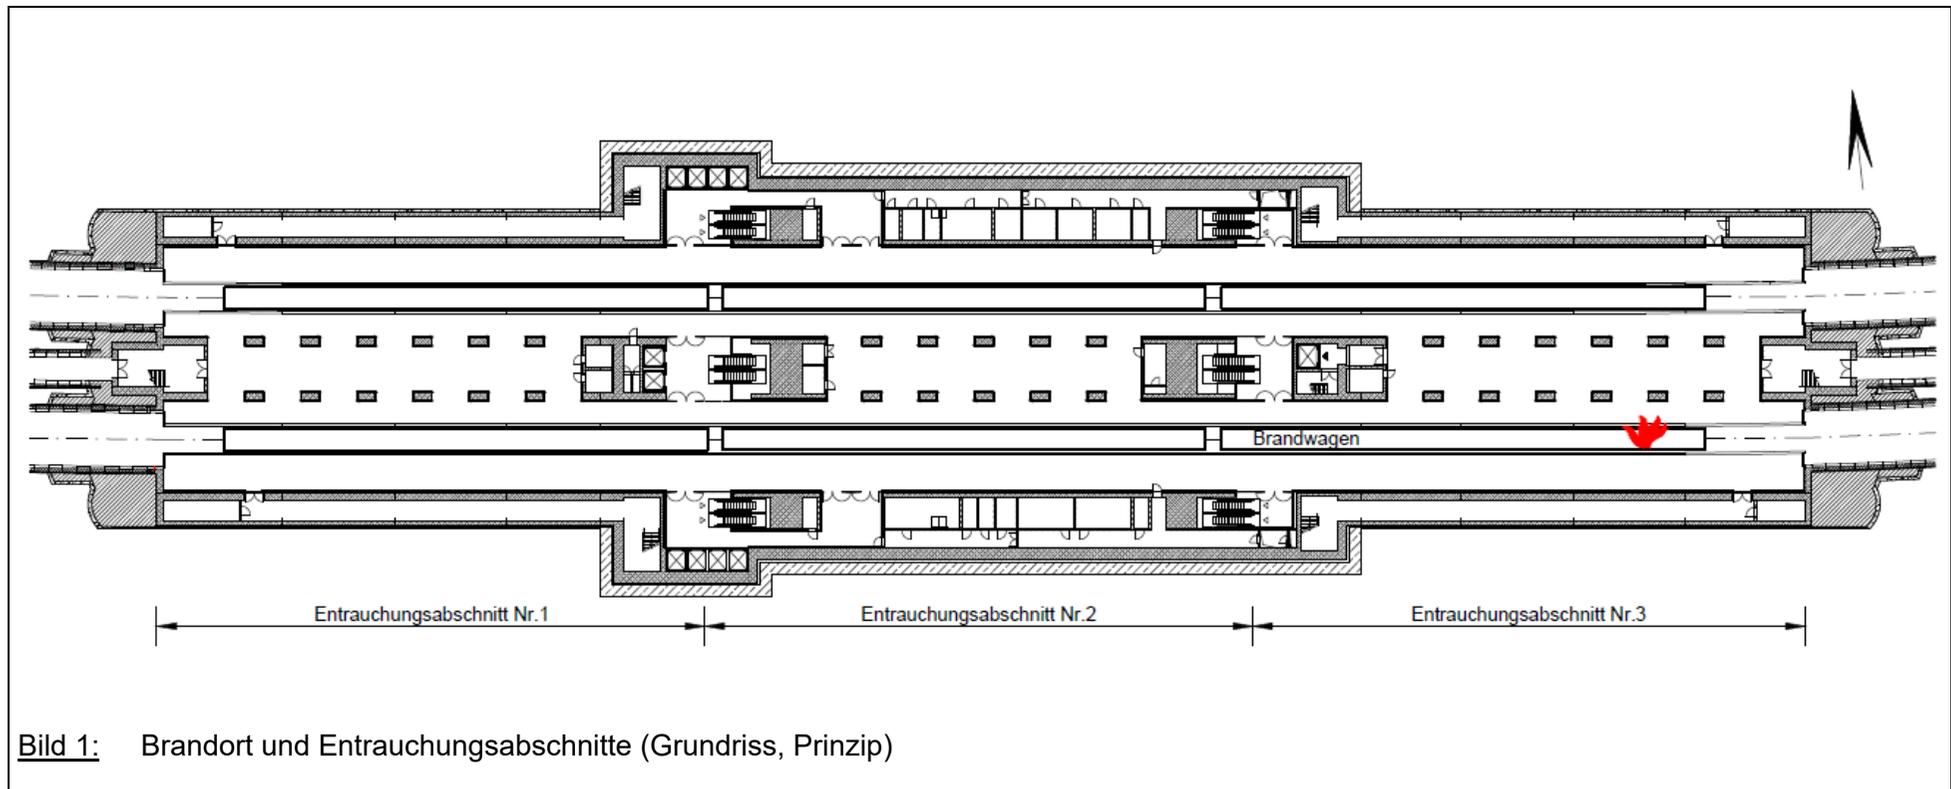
Brandort und Entrauchungsabschnitte (Grundriss, Prinzip)
